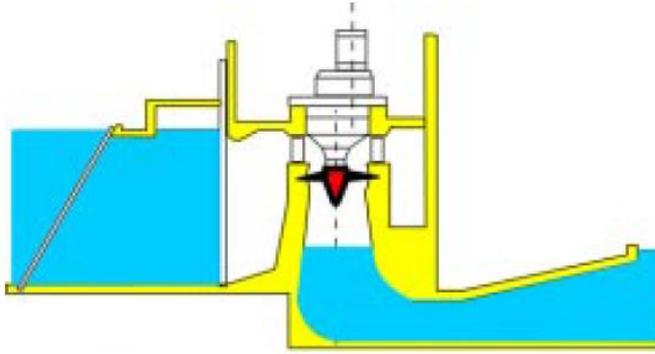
Kaplan o Semikaplan vertical. Multiplicador en paralelo al eje (ESHA, 2006)
